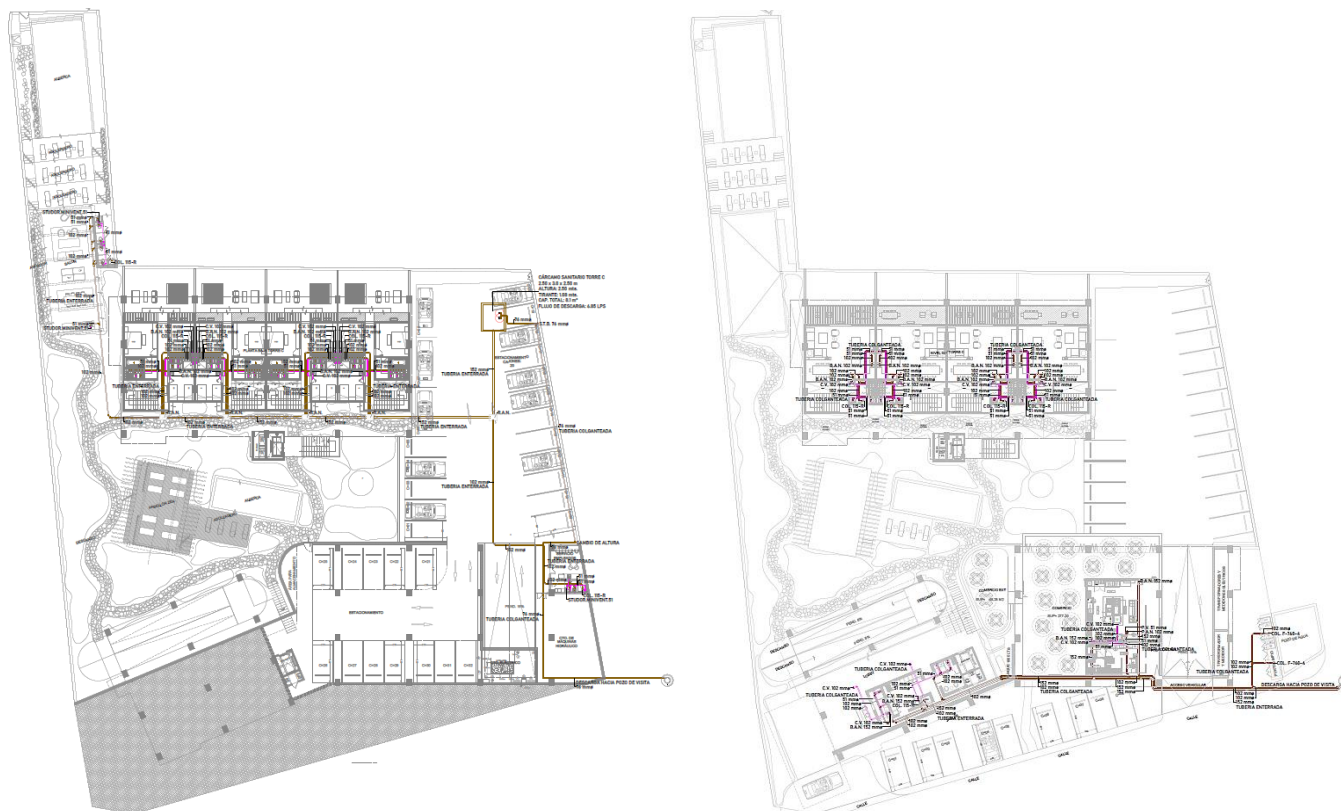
Instalación de la red de drenaje sanitario en el nivel de sótano y planta baja del proyecto
